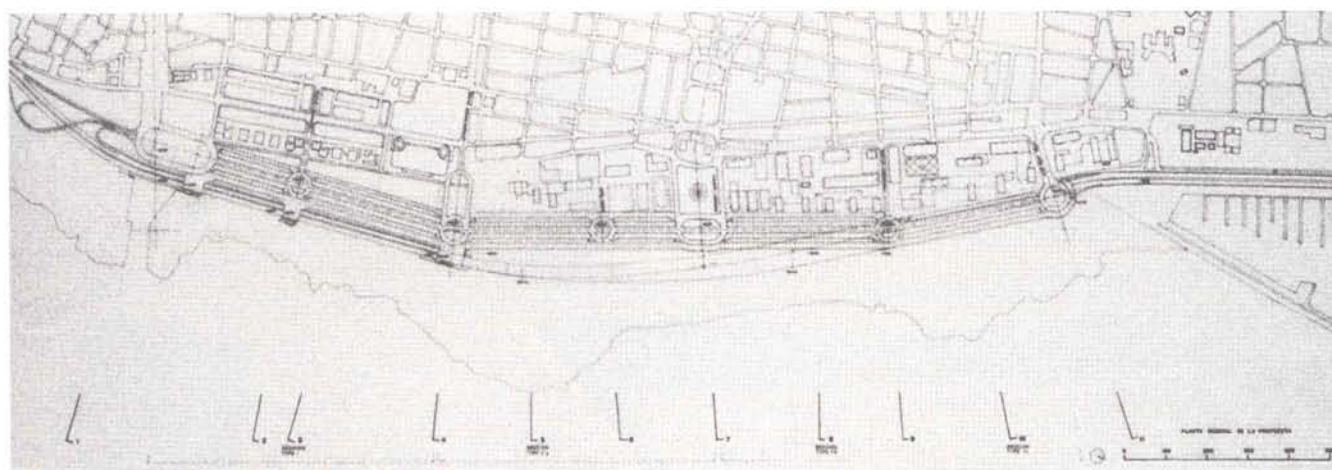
Planta de la última solución. Propuesta de bulevar y de nueva autovía desplazada en paralelo incorporando zonas de autovía enterradas bajo el bulevar. Dado el alto grado de consenso necesario en un proyecto de esta importancia para la ciudad, se contó con todas las administraciones implicadas en el futuro de la ciudad: Ayuntamiento, Gobierno de Canarias representado por la Consejería de Ordenación, y Cabildo Insular, así como diversos intelectuales y profesores de la universidad. Después de múltiples reuniones, se pactó una solución en la que la nueva autovía discurrese en algunos de sus tramos enterrada bajo el trazado actual.
